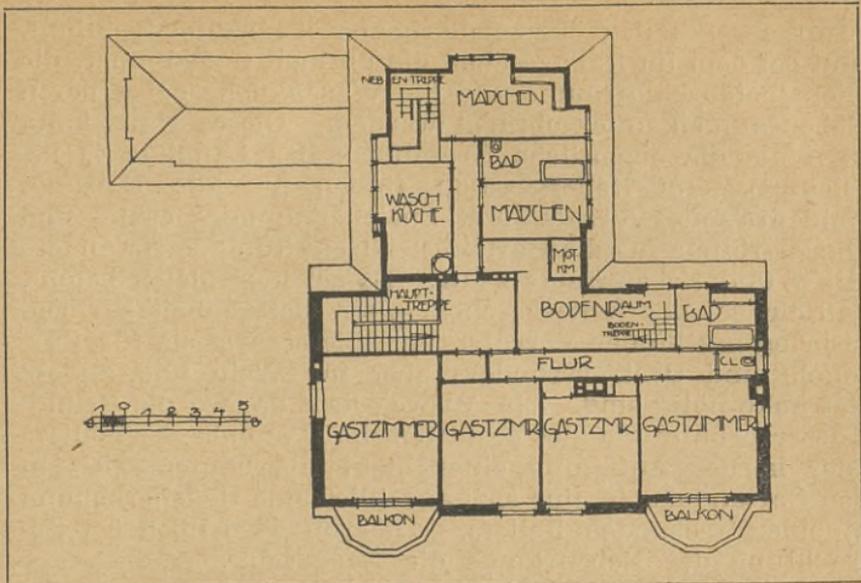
Dachgeschoß mit reichlichen Gastzimmern, in das die Haupttreppe hinaufgeführt ist
